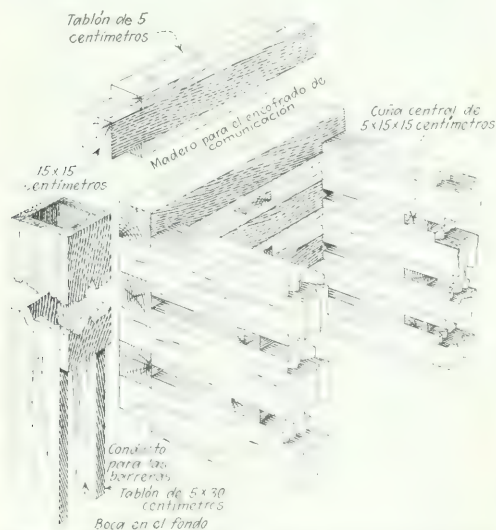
DETALLES DE UN ENCOFRADO CON CONDUCTO PARA LAS BARRERAS
